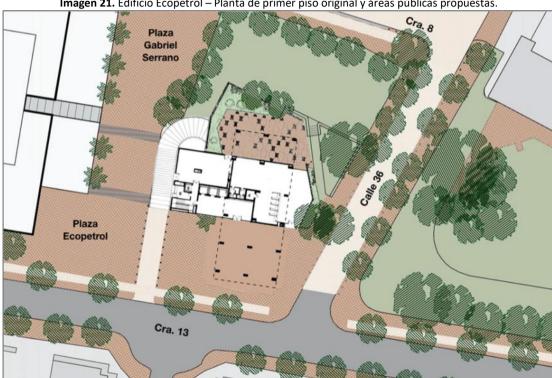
Edificio Ecopetrol – Planta de primer piso original y áreas públicas propuestas.
